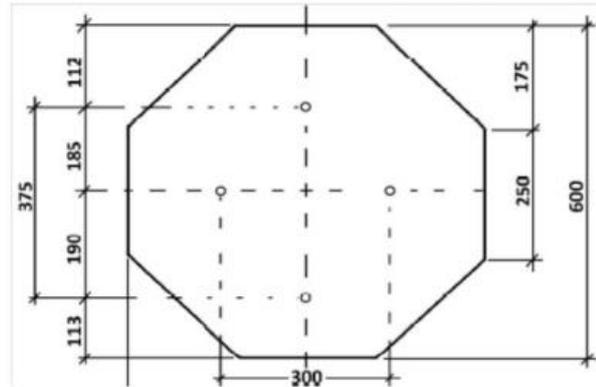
Detalhe do Dispositivo Anti-Giro e da Fundação
